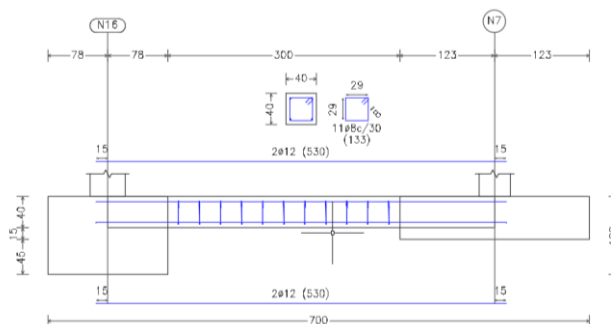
Características de la viga perimetral entre pilares que están a 5 metros.
